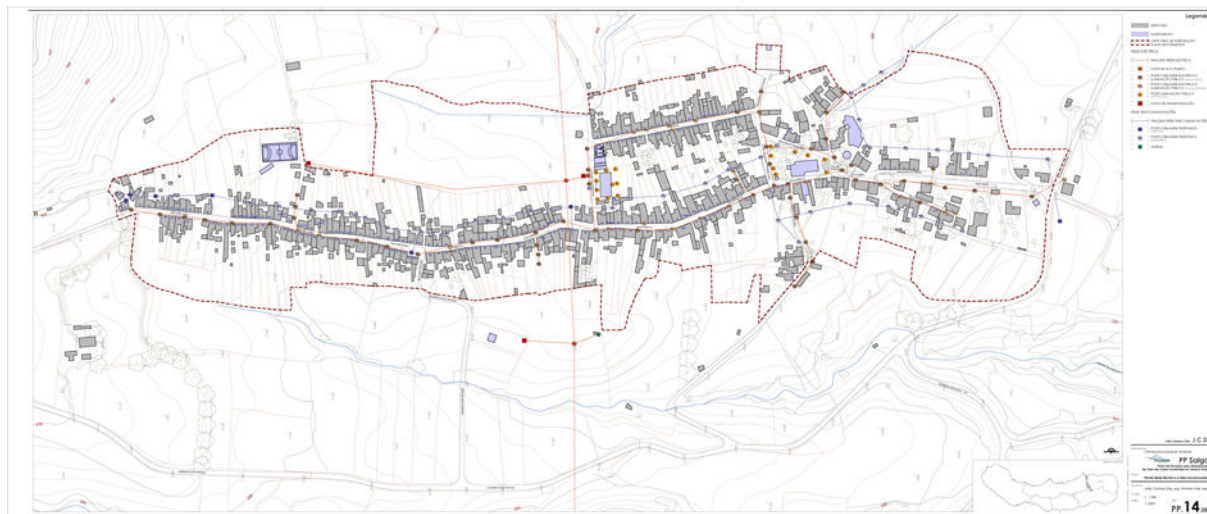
Planta Rede Eléctrica e Telecomunicações (ver planta PP.14.08)
